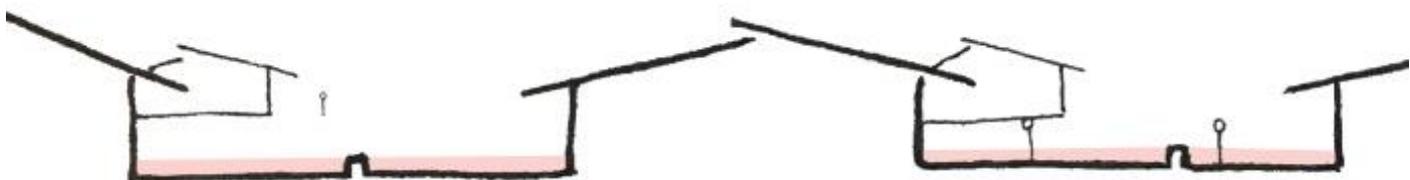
LOCAL DE ENTRADA EM ZONA DE VIZINHANÇA
